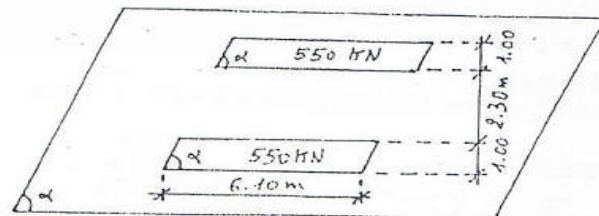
Exemple de disposition en plan d'un véhicule Me 120 dans un pont biais.
